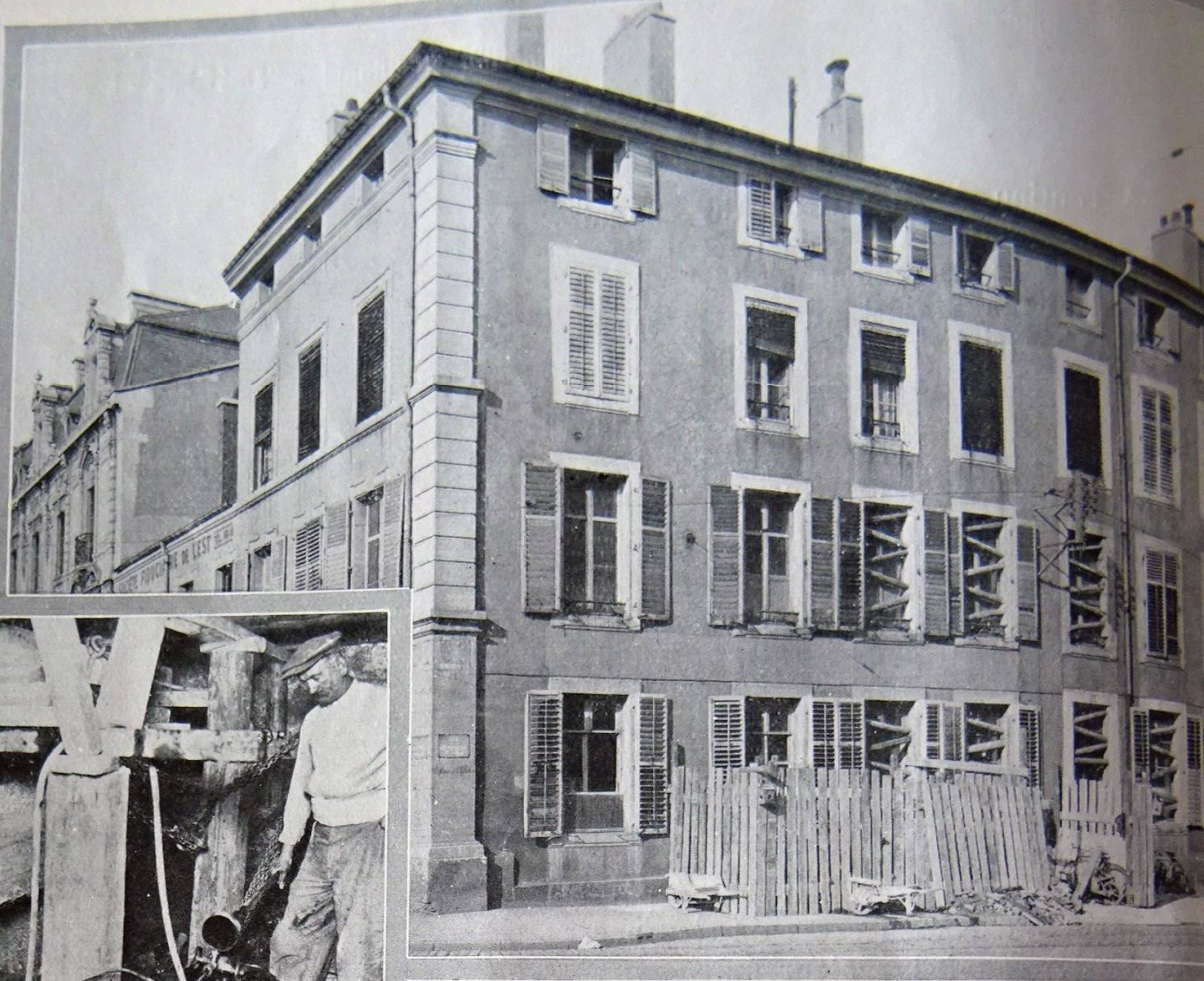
Renforcement des fondations d'un immeuble à Nancy, au moyen des pieux M (Architecte: J. Bourgon. — Entreprise: Bichaton et
